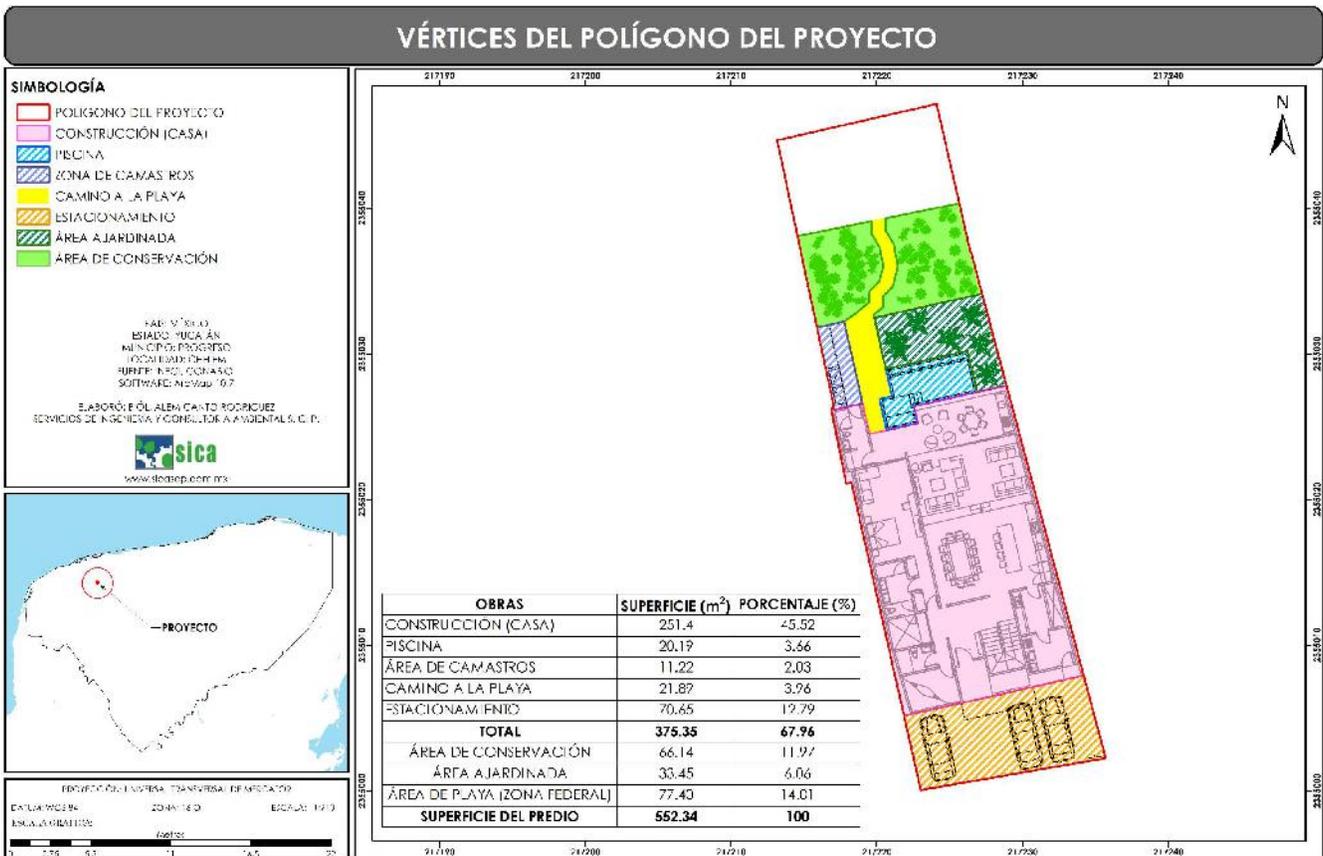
Plano con el diseño de las obras constructivas del proyecto
